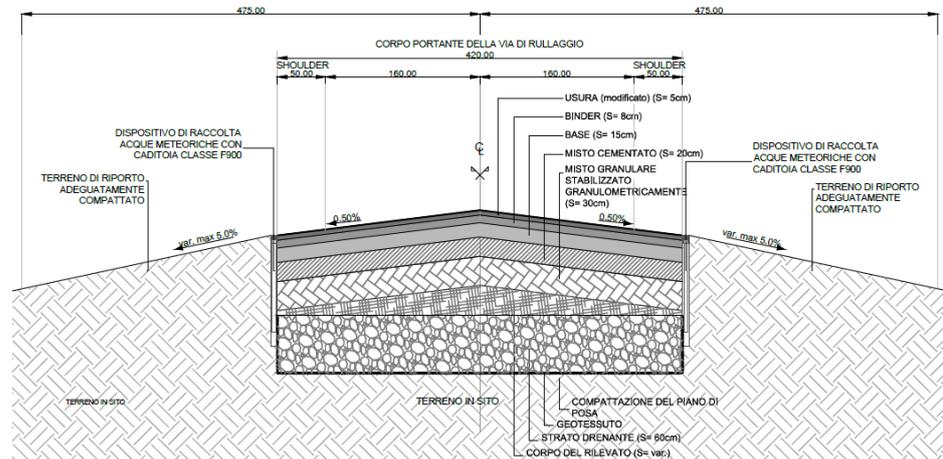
Sezione costruttiva del pacchetto multistrato
